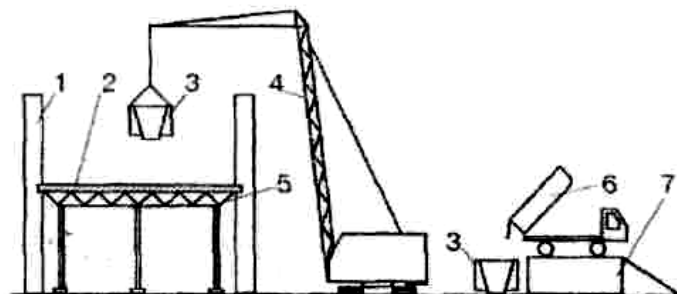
Схема бетонування конструкції з використанням опалубки начісування:
